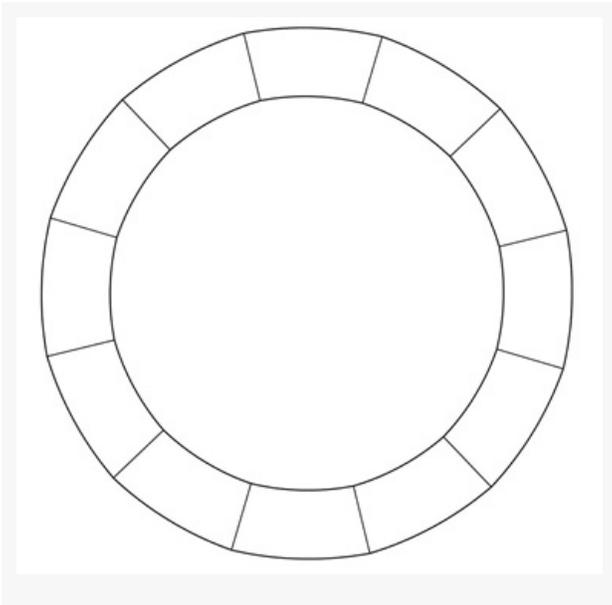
CORTE DE PLANTA DEL TRAMO FACETEADO.
